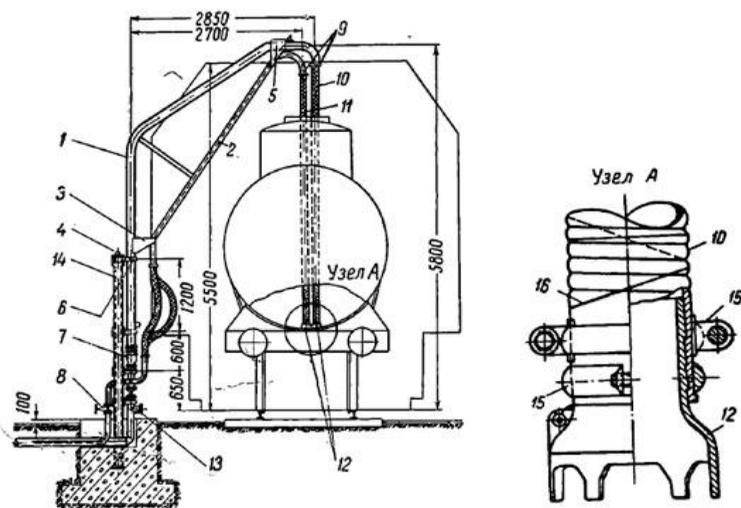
Сливо-наливной стояк: 1 – стояк; 2 – зачистная труба; 3 – косынка; 4 – стопор ограничителя; 5 – накладка; 6 – хомуты; 7 – поворотный сальник; 8 – задвижка; 9 – устройство для соединения рукавов с трубами; 10 – резиновый рукав; 11 – резиновый рукав для зачистки; 12 – наконечники к рукавам; 13 – патрубок для нижнего слива; 14 – опорная стойка; 15 – хомут; 16 – провод для заземления.
